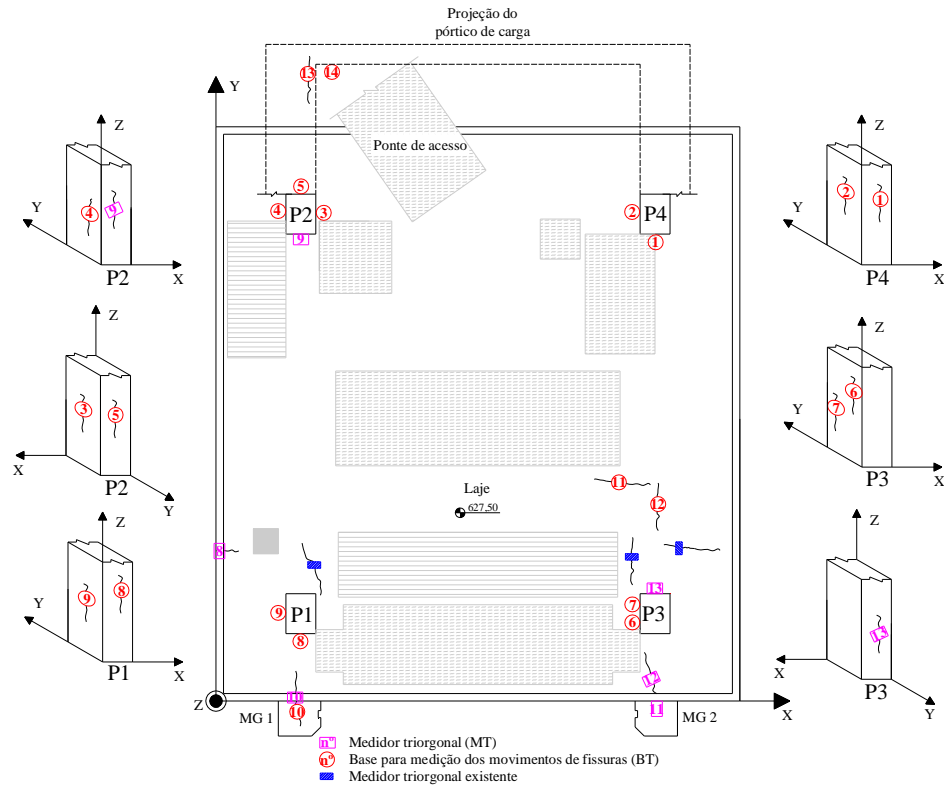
Localização de MT e BT na laje, pilares e pórtico de carga. Vista em planta e projeções
